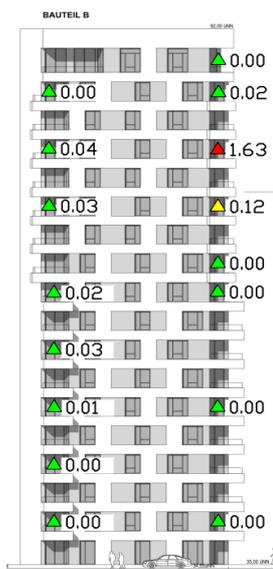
Windgefahren auf Balkonen von Bauteil B ohne Maßnahmen, Südfassade
